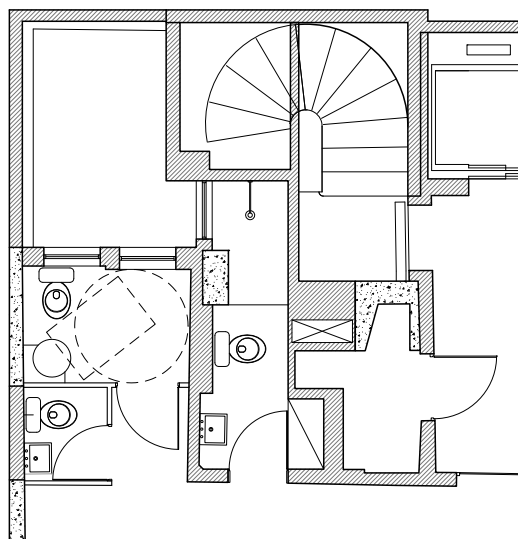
Planta - Novos sanitários no térreo - 1:100
